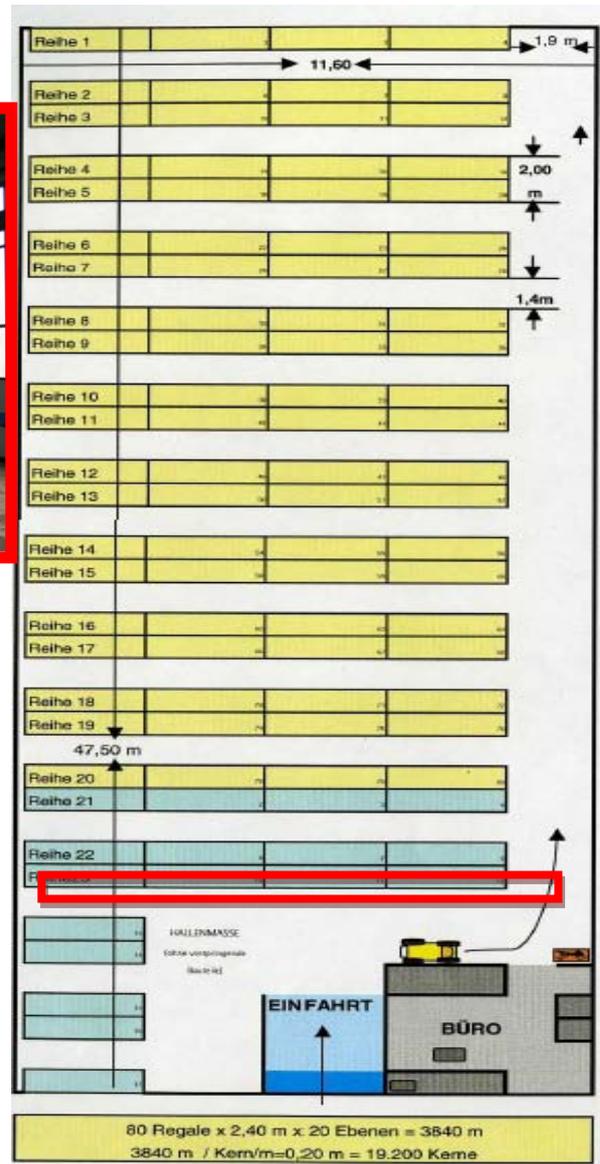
GBA – Grundriss Bohrkernlager
